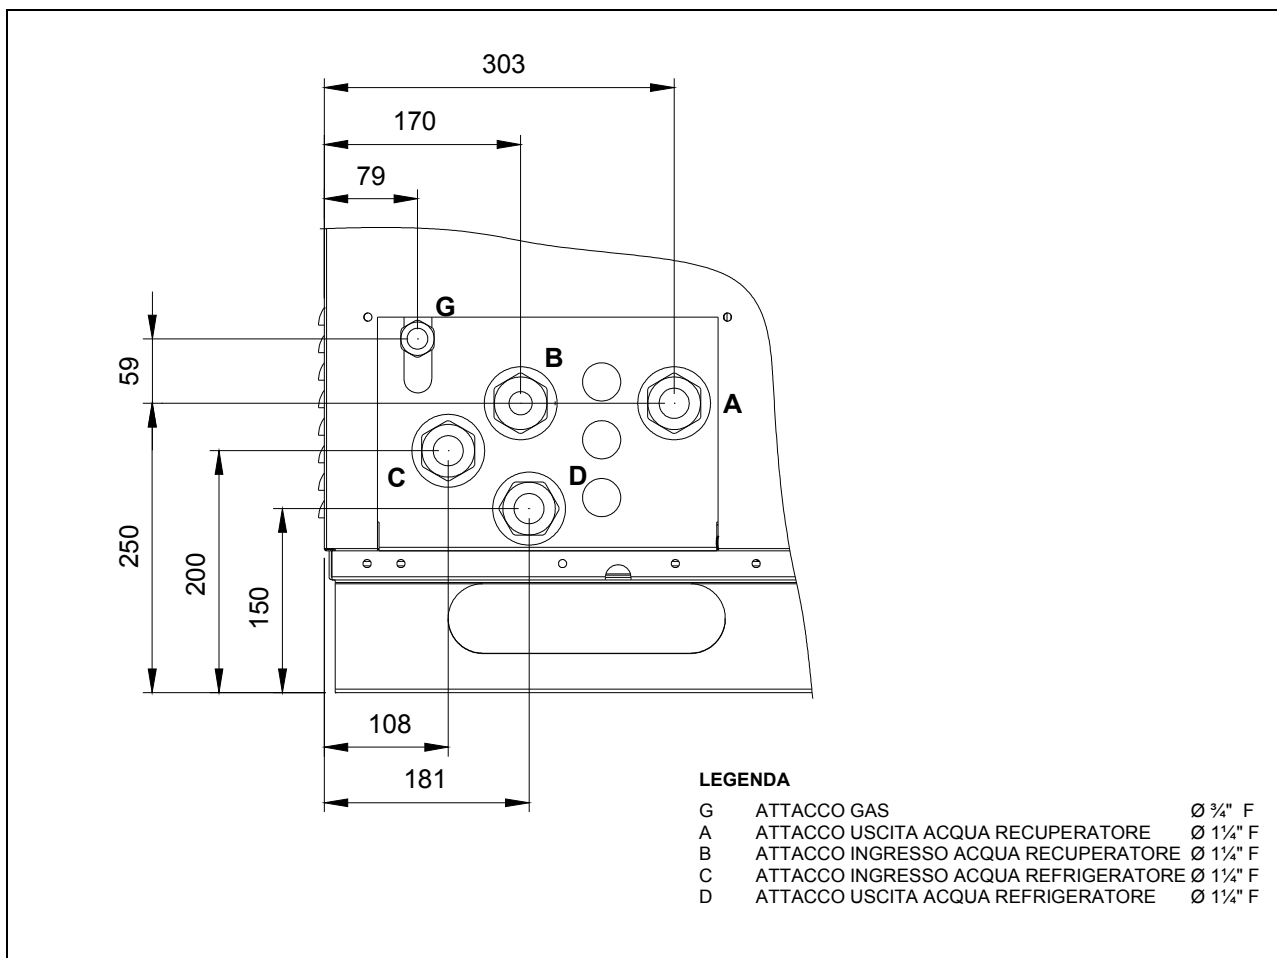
Piastra servizi GA ACF versione HR - dettaglio attacchi idraulici/gas (quote espresse in mm)
